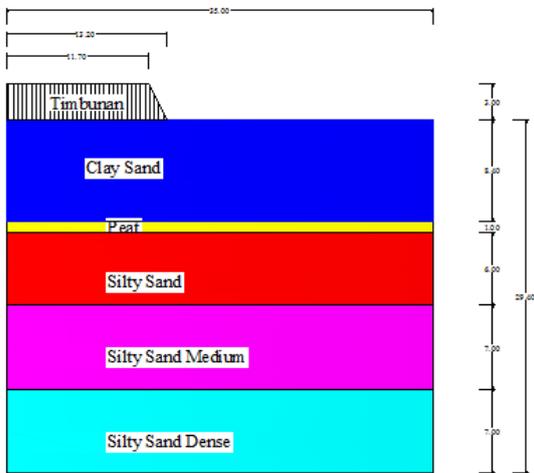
Profil Konstruksi Lereng Timbunan
